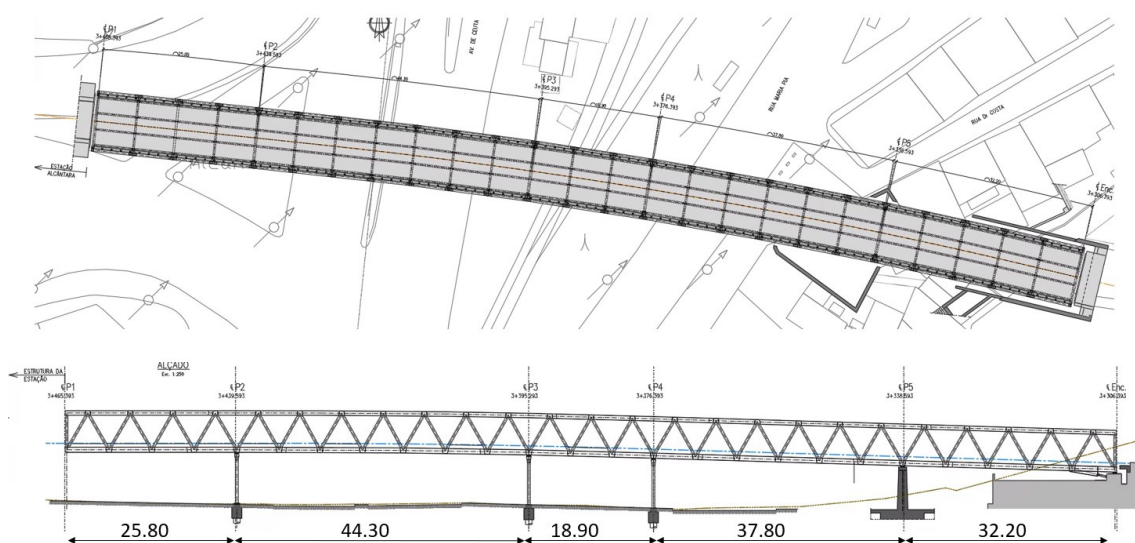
Planta e Alçado do Viaduto (vãos)
